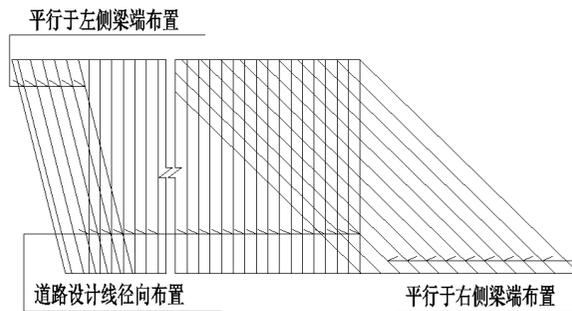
箱梁钢筋-横向钢筋布置-中间正布、两端斜布
